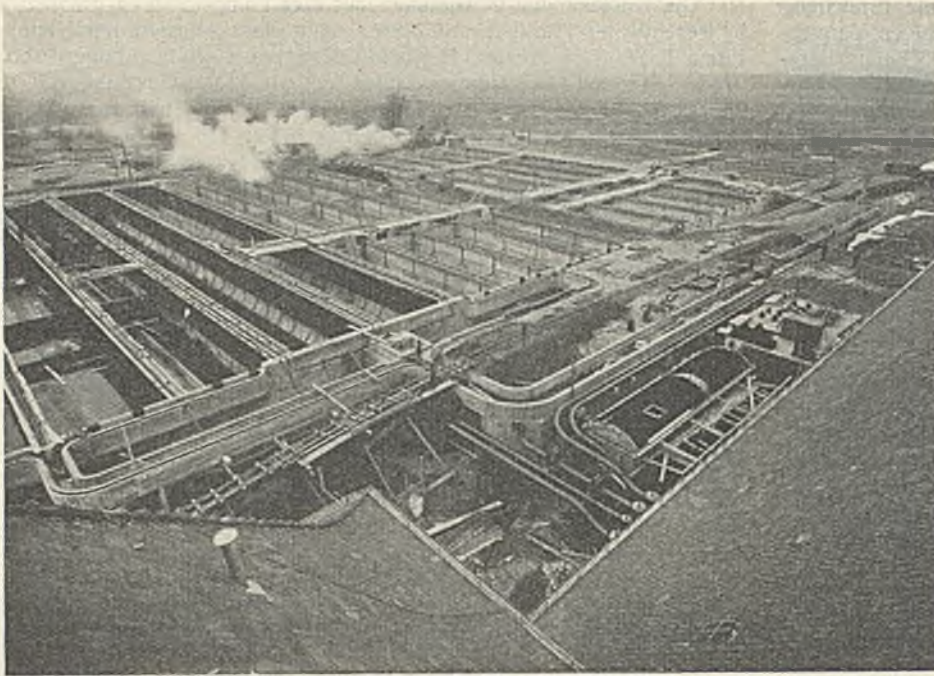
Führung der Luftrohre für die Belebtaanlage.
